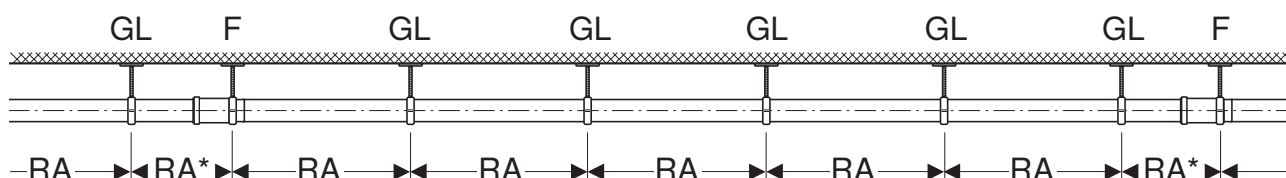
Distances entre les colliers RA en cas de fixation à des plafonds et horizontalement à des murs, sans coques
